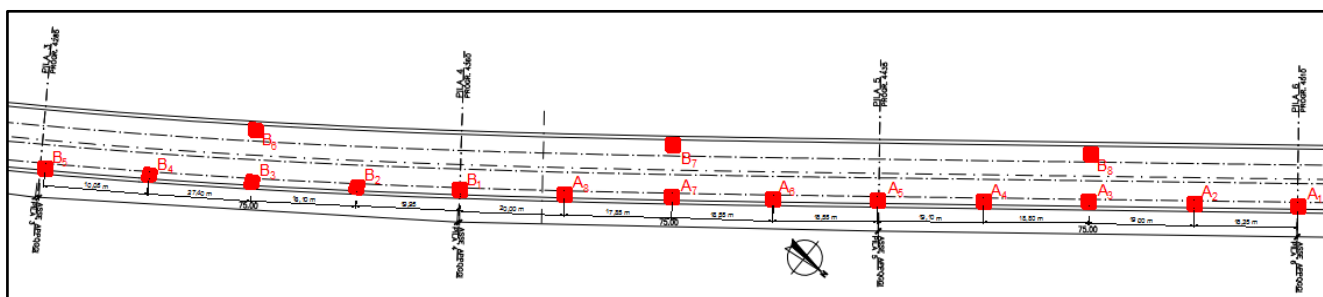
Disposizione strumentazione Campate 4 – 5 – 6
